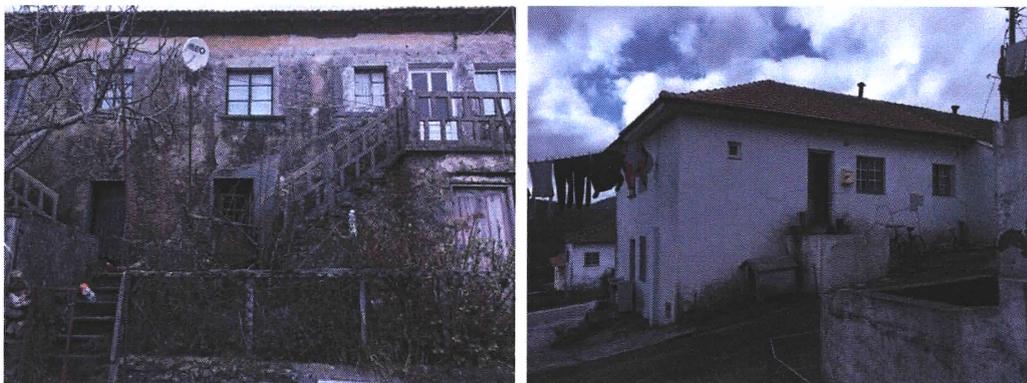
Vistas do Bairro Novo da Borralha (2020)
